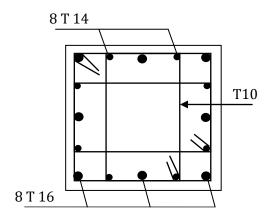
Schéma de ferraillage des poteaux 4éme, 5éme étage.
